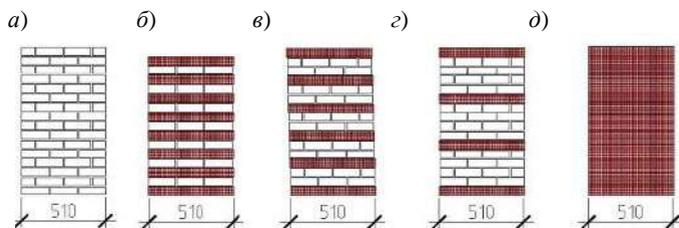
Схемы армирования композитными сетками при испытании образцов на сжатие:
